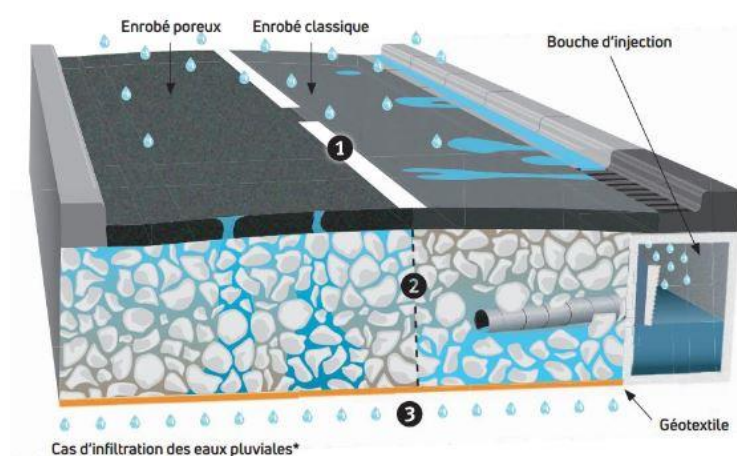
Fonctionnement d'une chaussée à structure réservoir.
